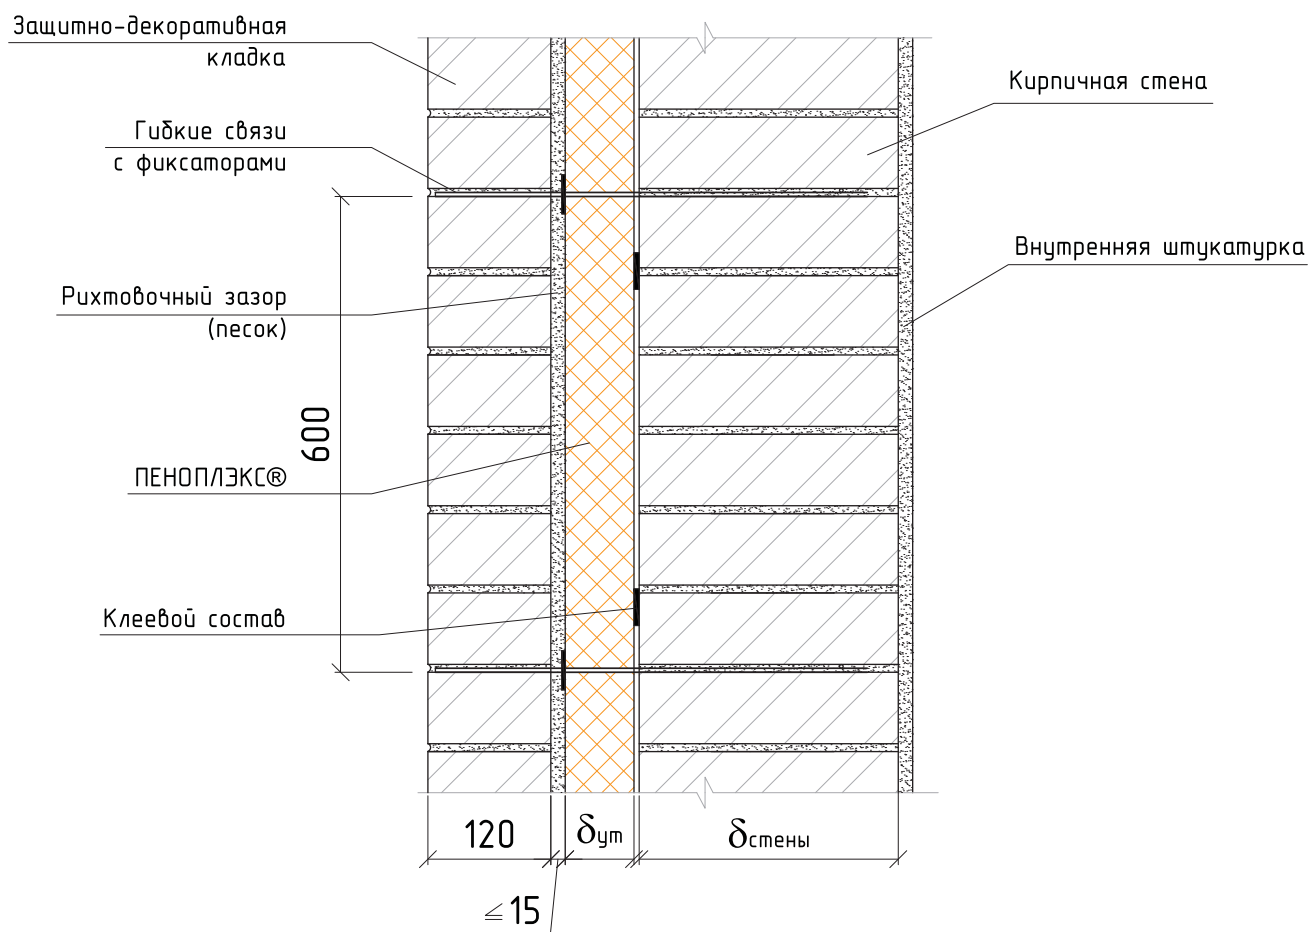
Схема конструкции стены первого или цокольного этажа №5
